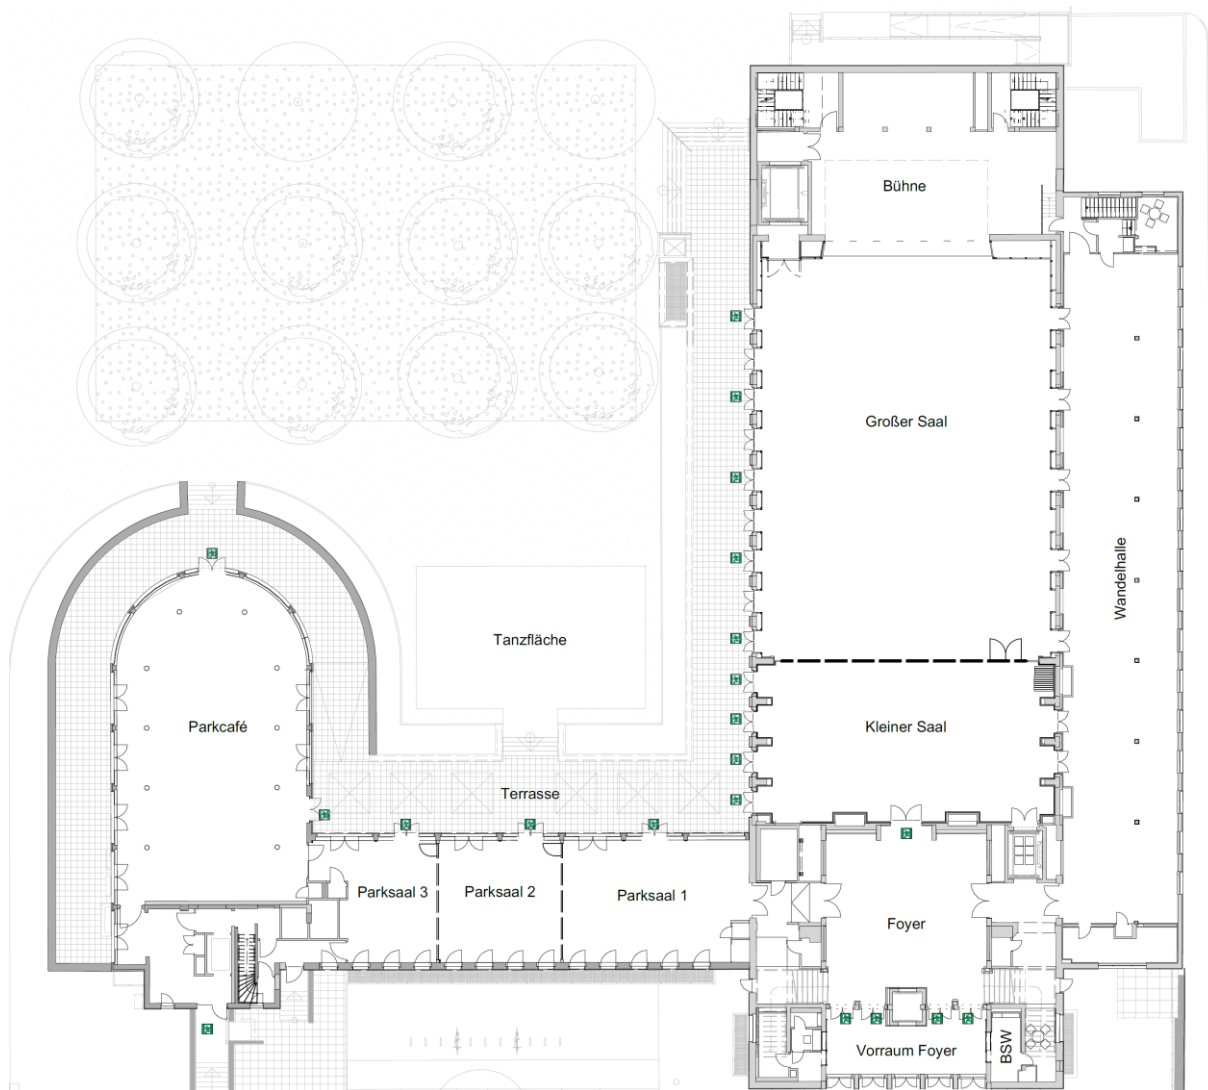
Grundriss Übersicht Festhalle und Parkcafé.
